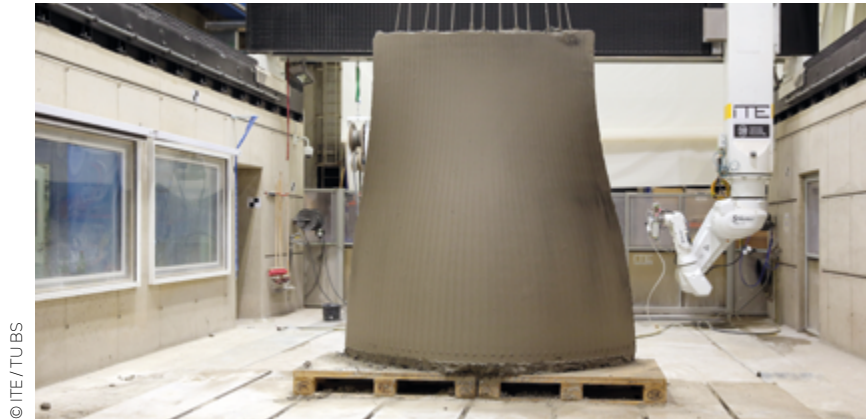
Im SC3DP-Verfahren gefertigte freigeformte und geglättete Betonwand mit integrierter Stahlbewehrung
